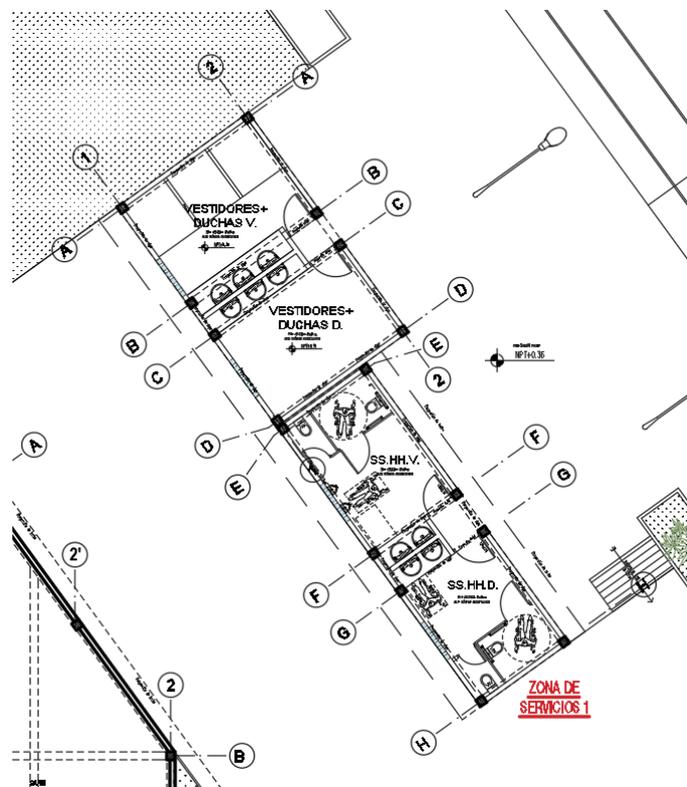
Distribución arquitectónica en planta del 1° piso, “Bloque C”
